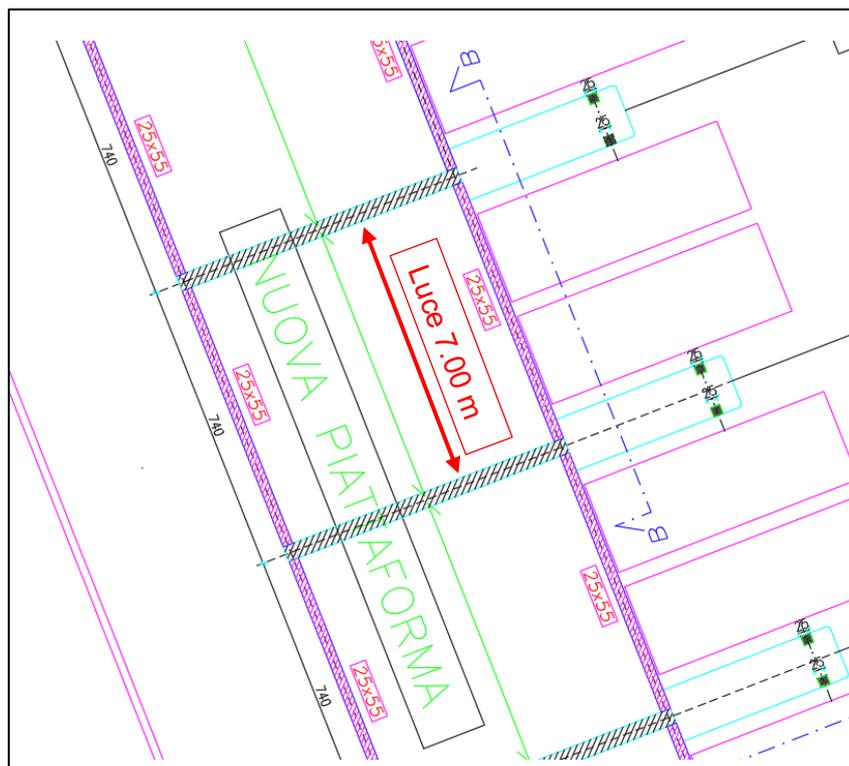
Pianta piattaforma con evidenziata luce libera tra le strutture in elevazione
